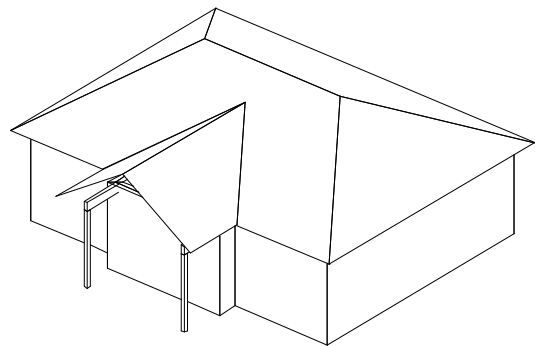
• Exemple d'un plan de montage de fermes de toit (MiTek Canada)
